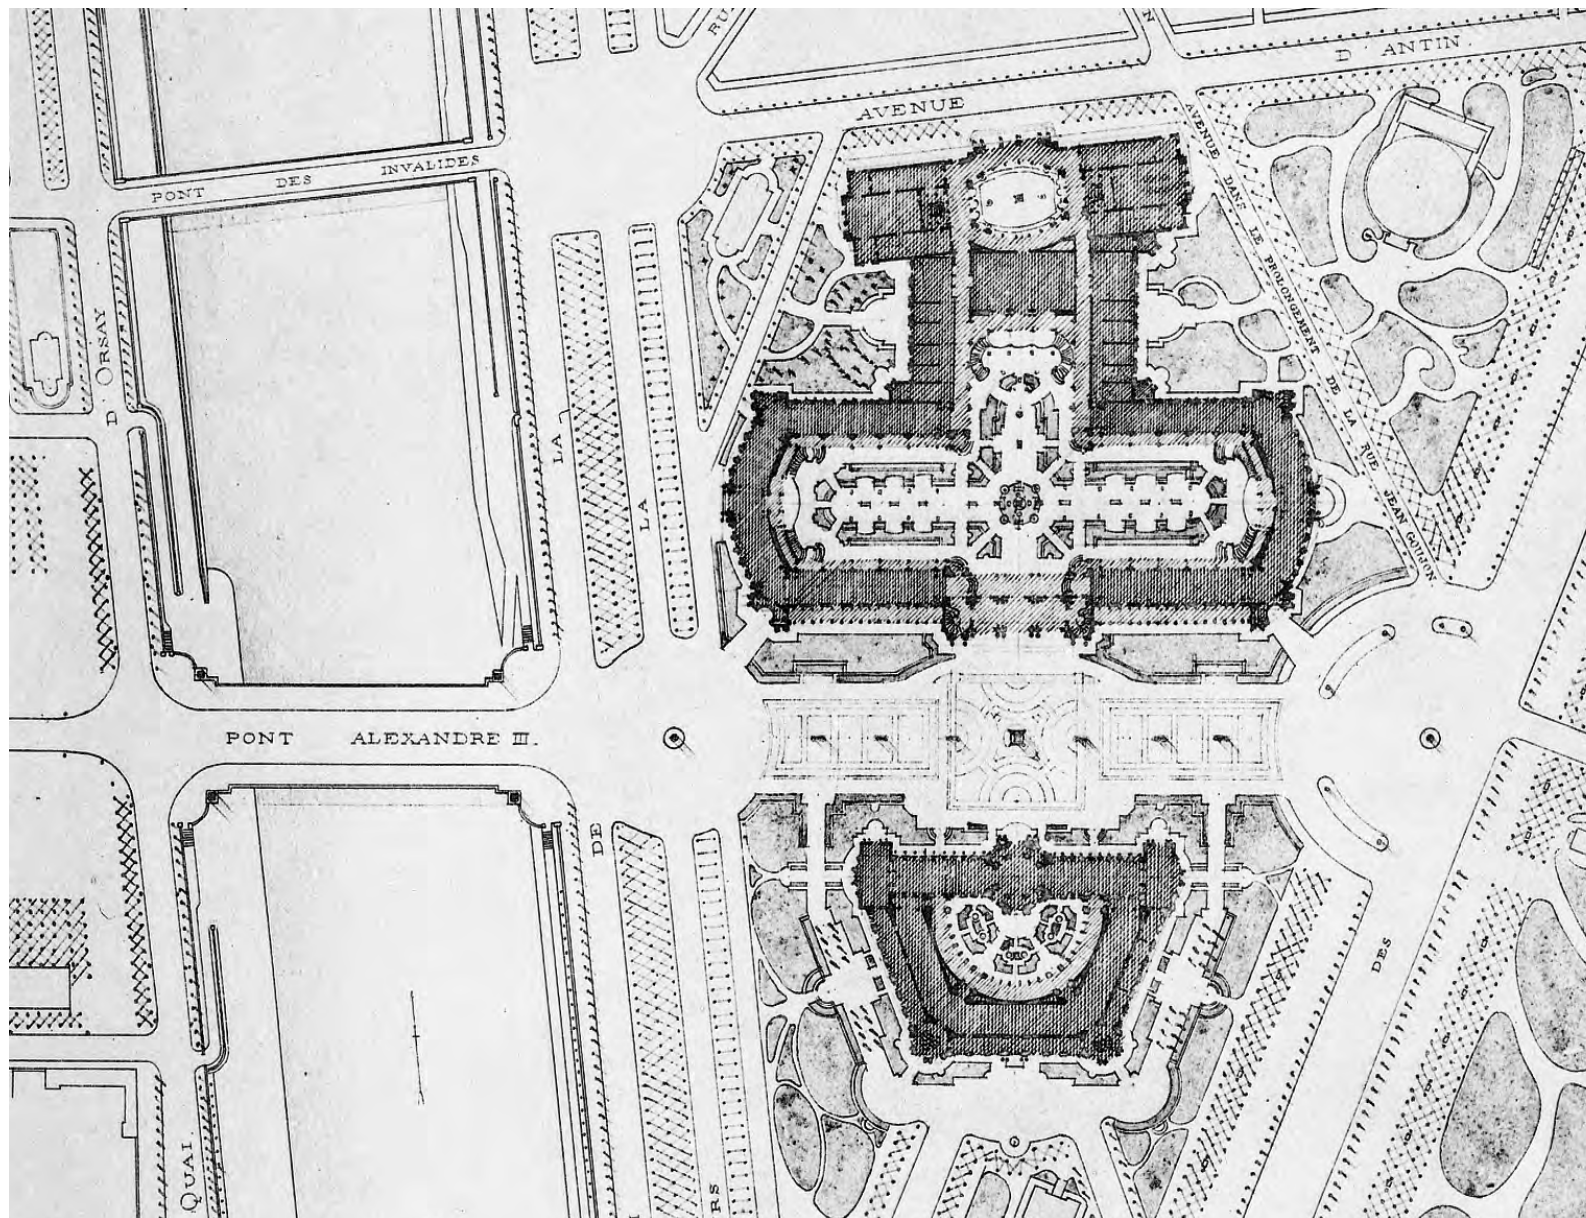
Ministère du Commerce de l'Industrie des Postes et Télégraphes. Exposition de 1900. Direction des Services d'Architecture. Plan d'Ensemble. Plano geral de implantação dos Petit e Grand Palais, Paris. Tinta sobre papel. (Fonte: Acervo BNF, Plan d'Ensemble, 1896)
